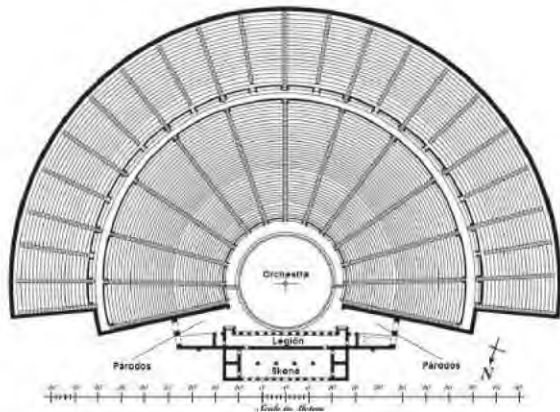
Planta esquemática del Teatro de Epidauro por Policleto el Joven. Siglo IV a.C. Fuente: anónimo.
